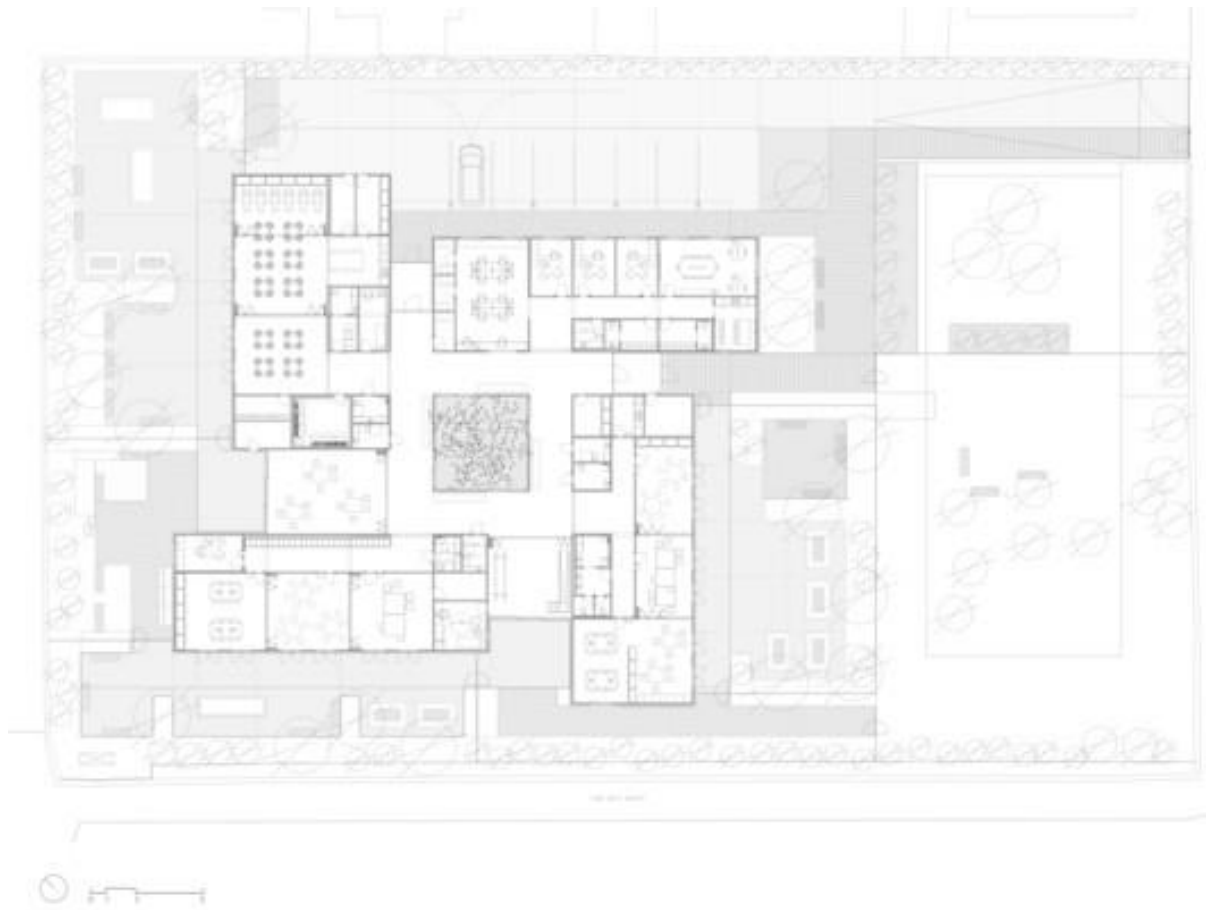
Планування Alzheimer's Day Center / GCA Architects [2]
